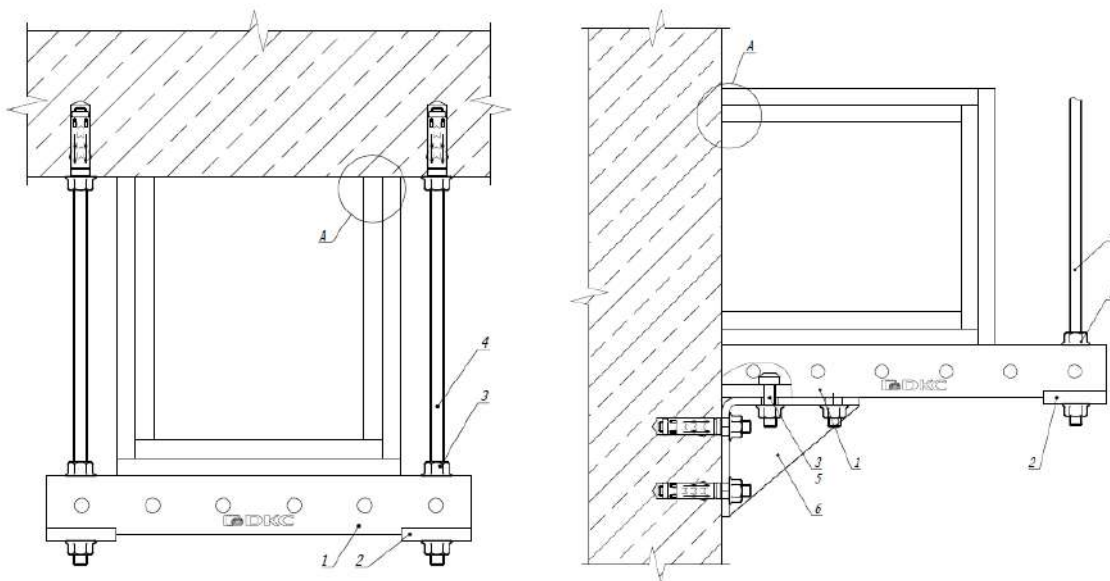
Крепление короба с тремя стенками к несущей поверхности
